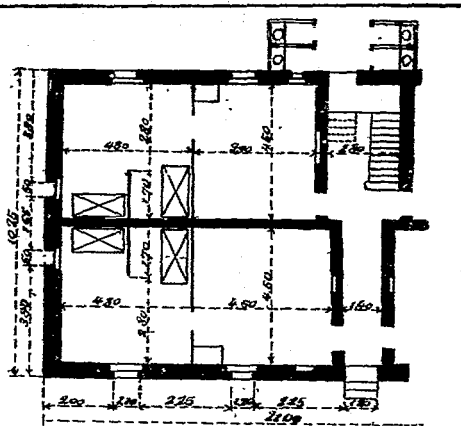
Demi-plan du rez-de-Chaussée d'une grande maison
